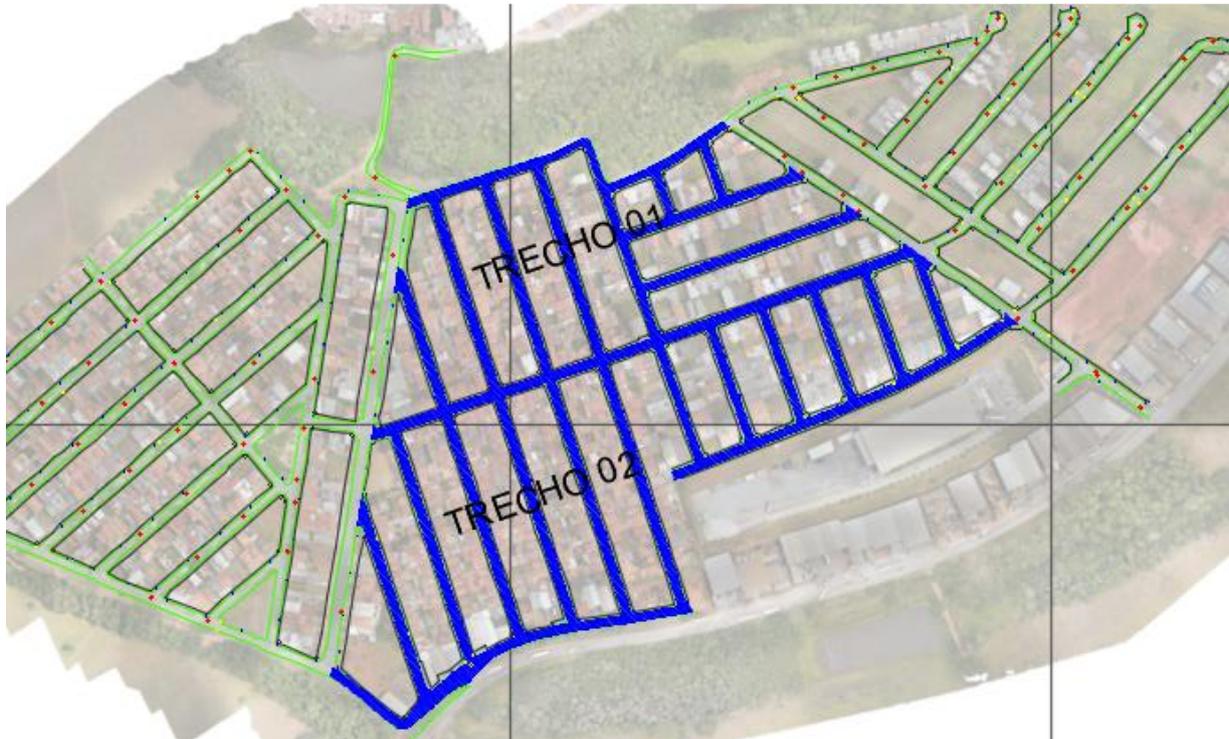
Área de Recapeamento do Pavimento do Bairro Morumbi
